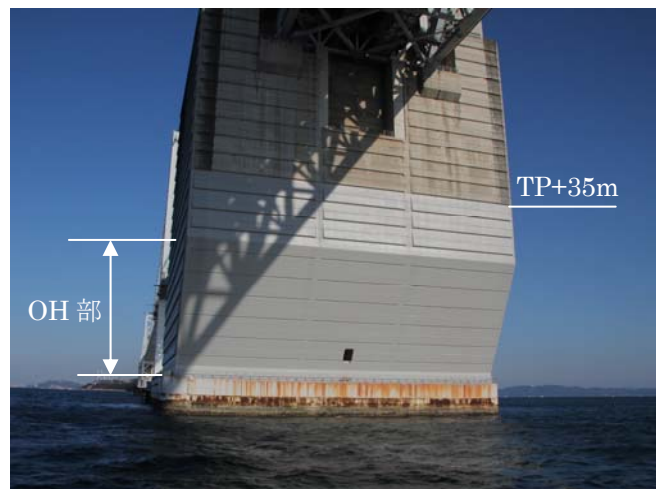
南備讃瀬戸大橋 7A 南面 OH 部の対策状況
